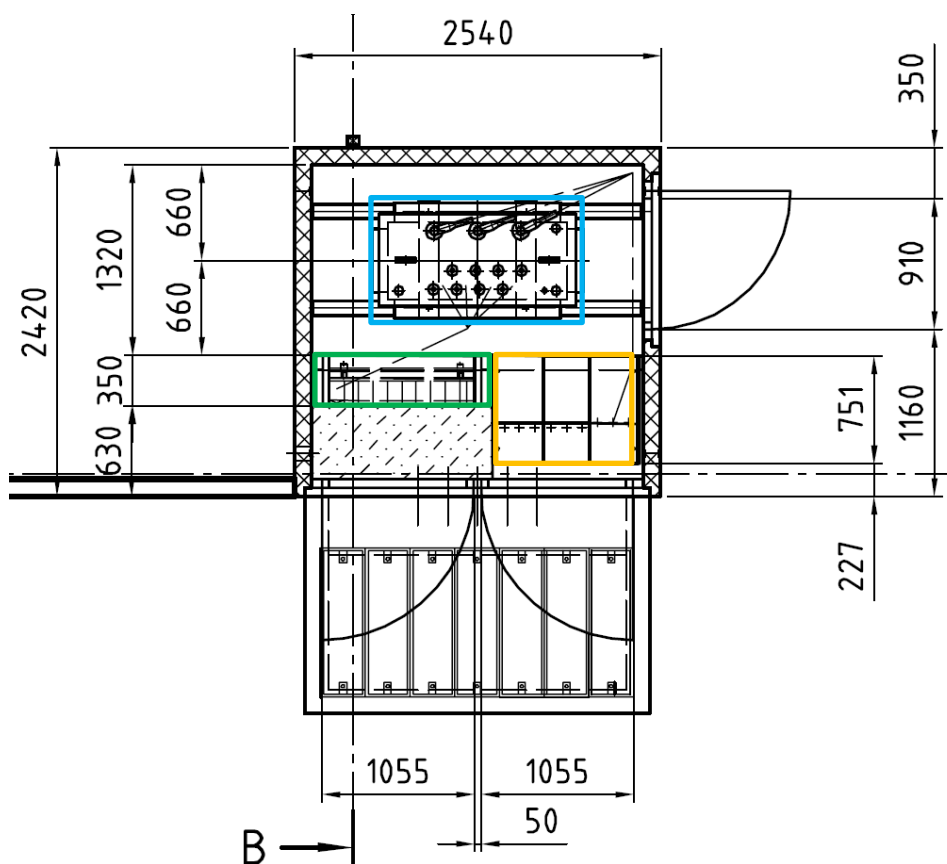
Grundriss der TS inkl. modellierte Anlagen
